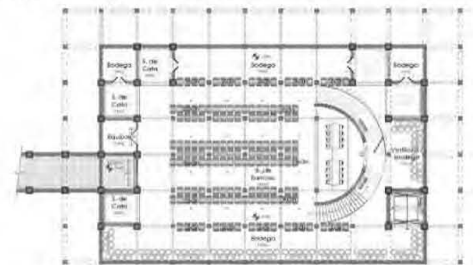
Vista en Planta del Edificio Principal Viñedo DeCote
